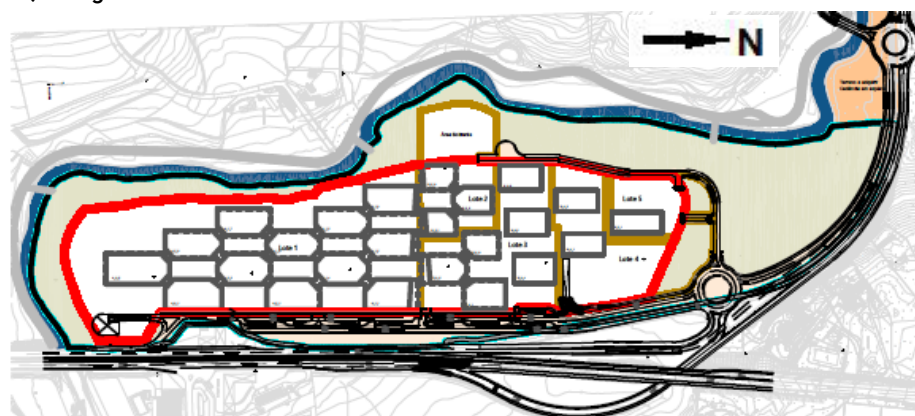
Cedências (Fonte: Planta Síntese - Anexo II ao Aditamento ao EIA - outubro de 2021).
